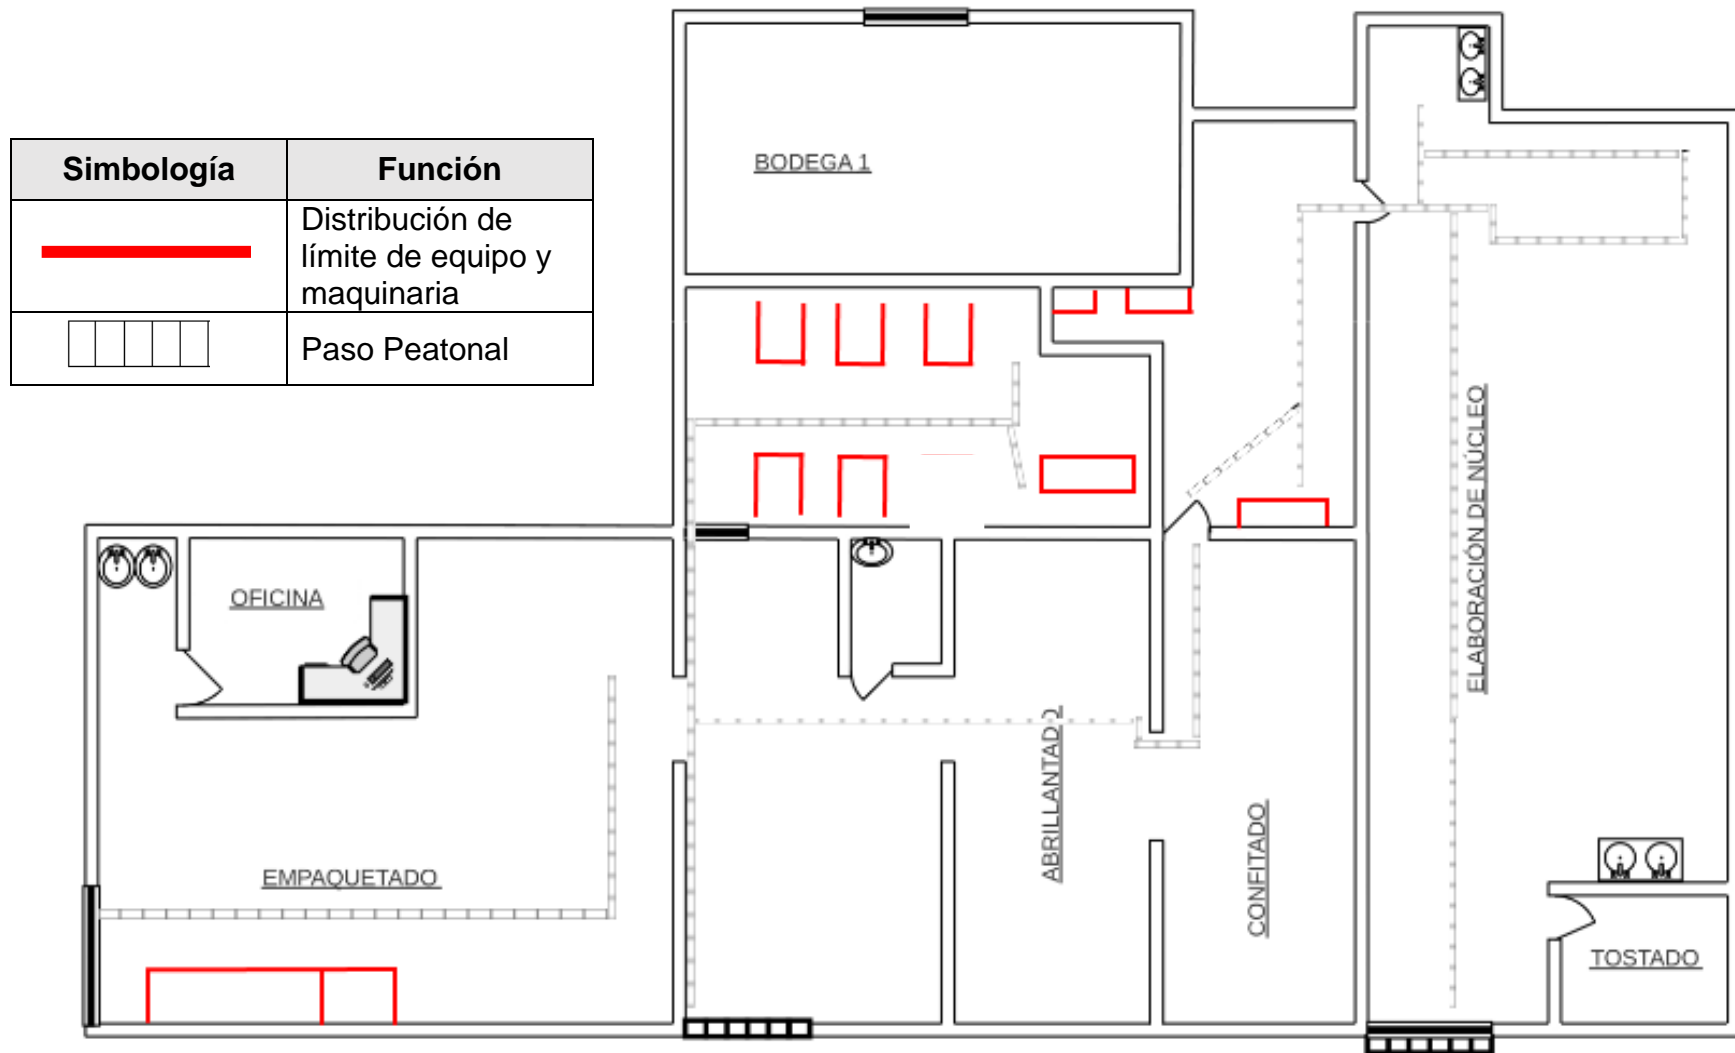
Ilustración de distribución de tráfico de Planta Confeitería
